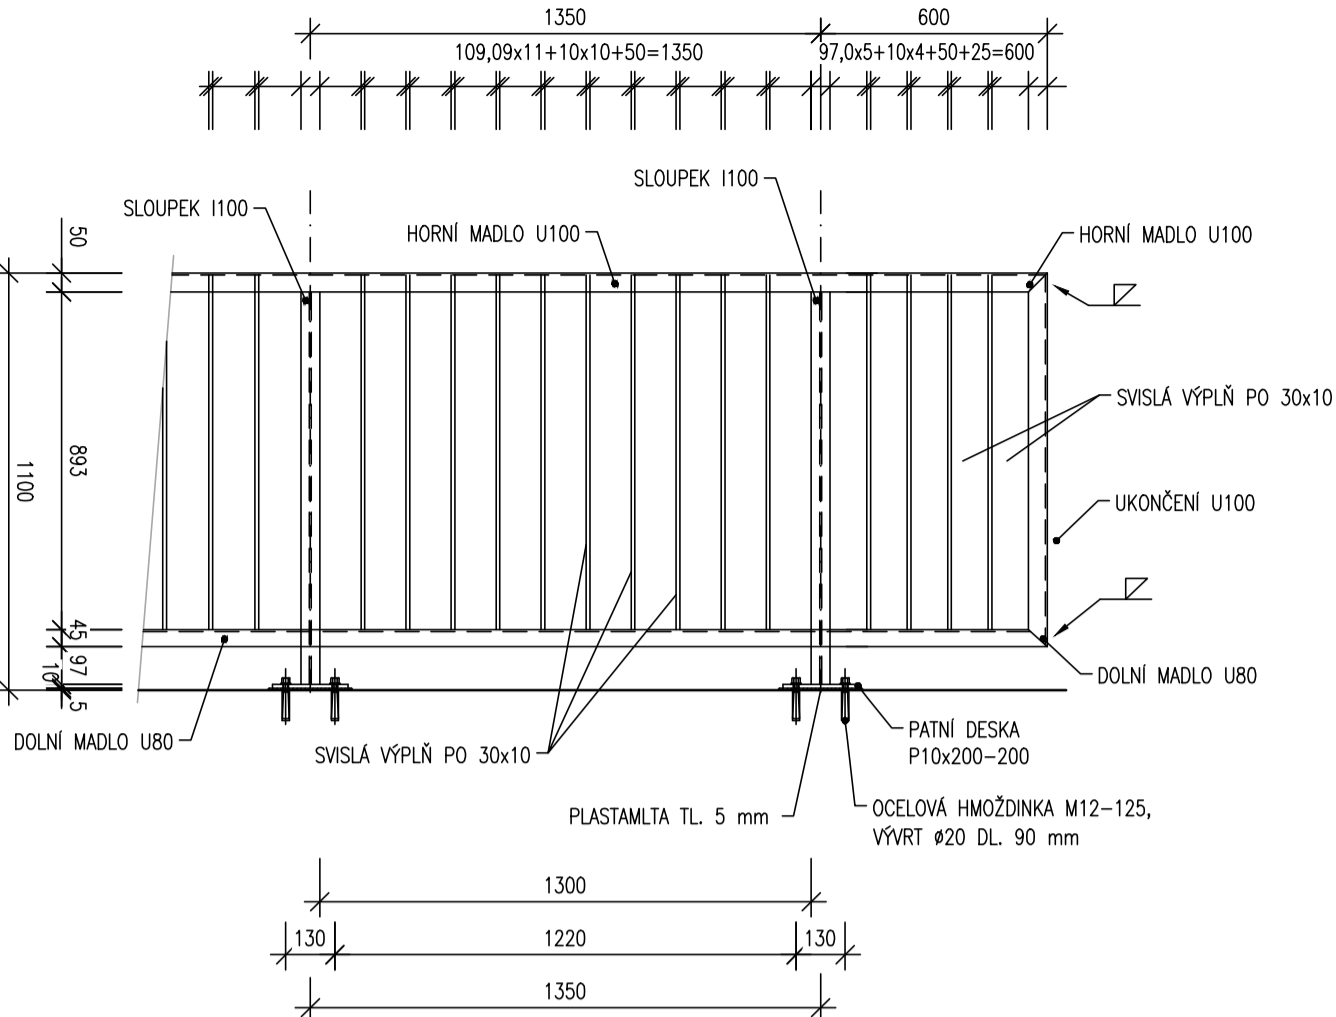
DETAIL ZÁBRADLÍ – UKONČENÍ 0,25 m 1:20
